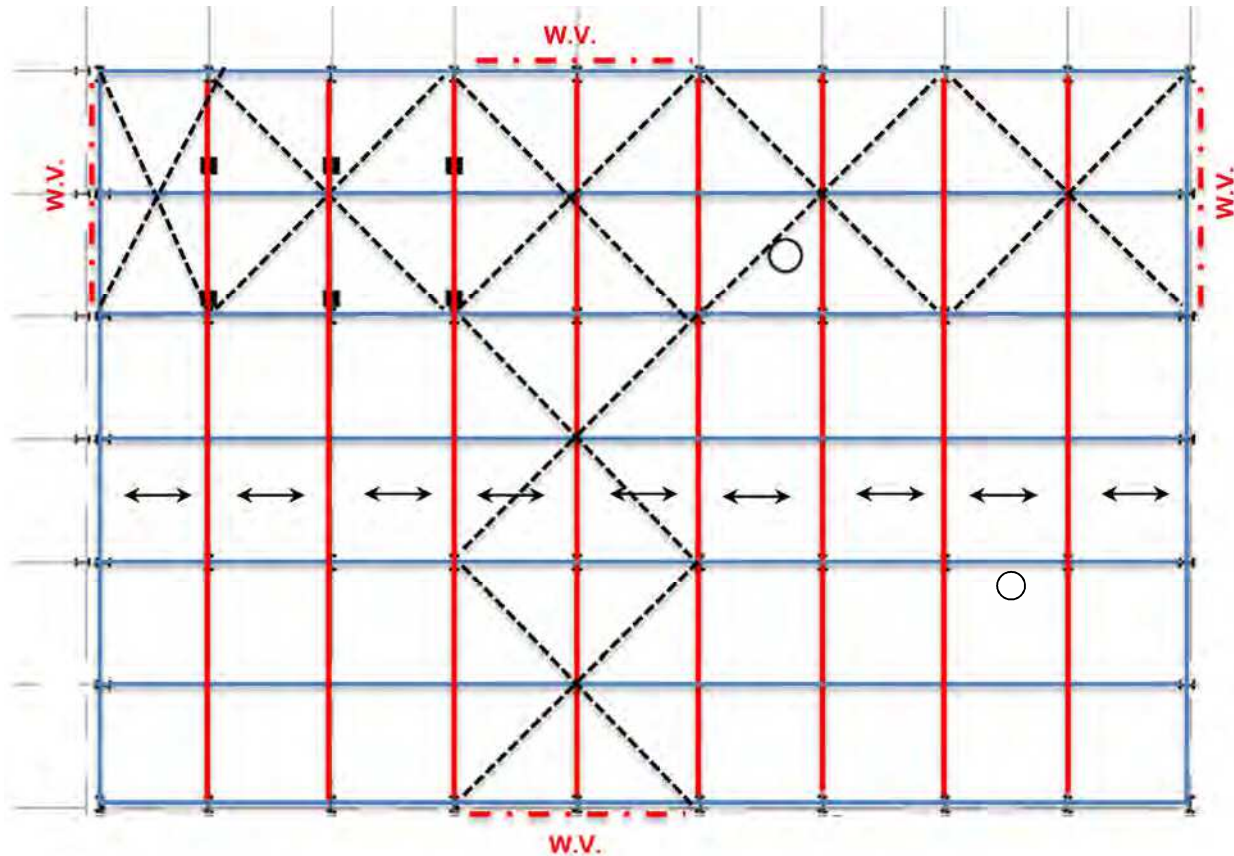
Schematisch overzicht dakconstructie, horizontale en verticale windverbanden
